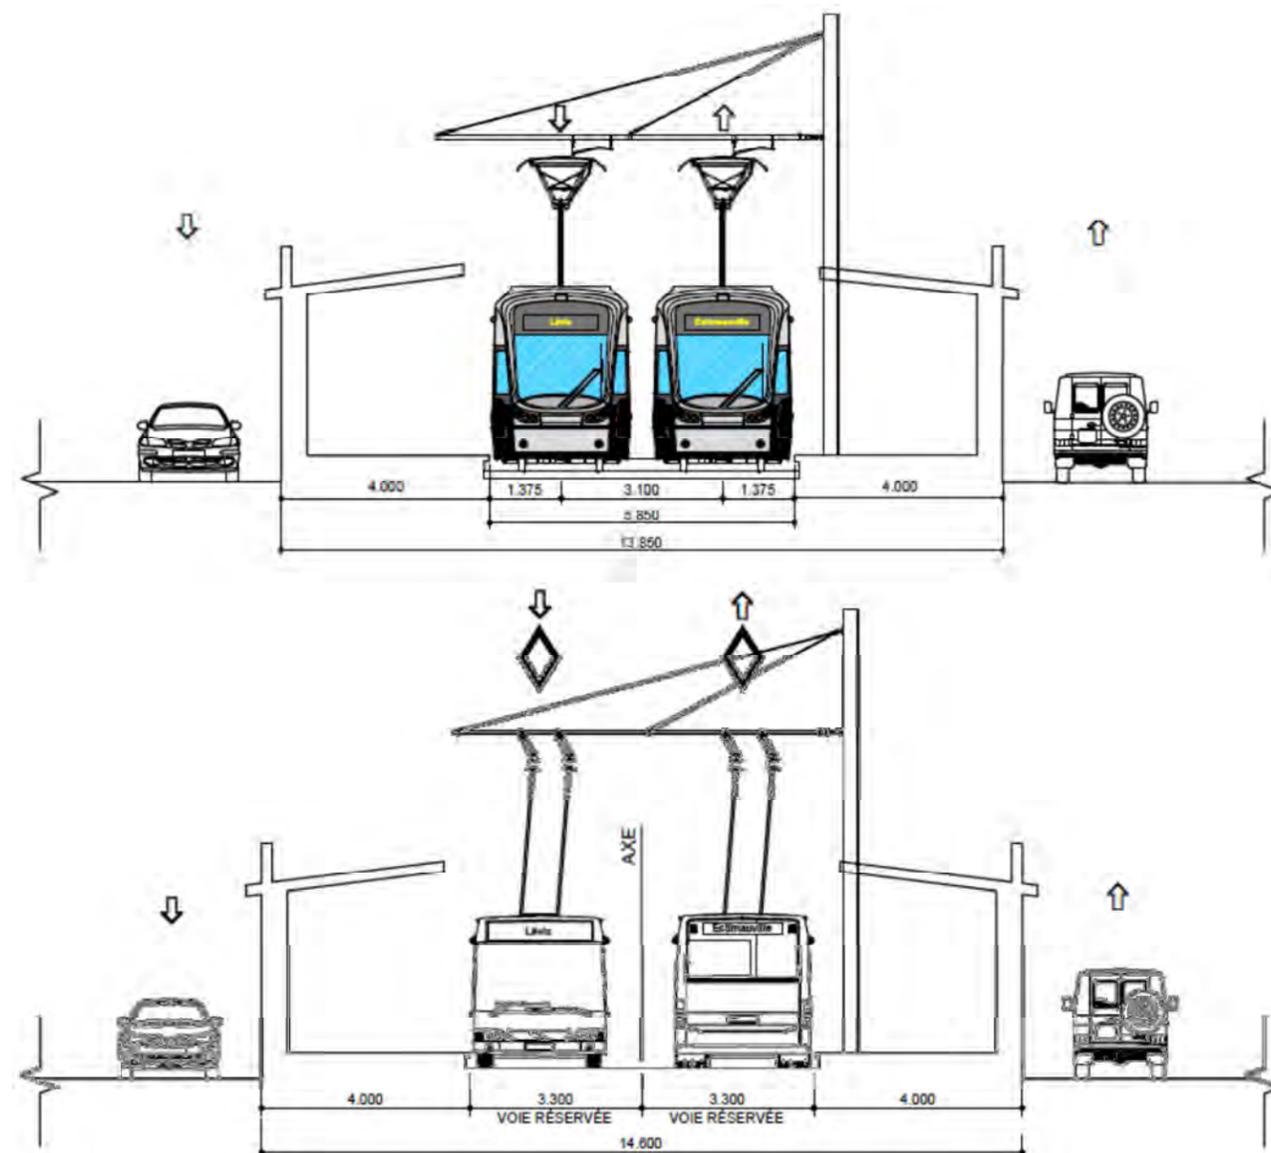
Coupe type 14 de 15 - SRB - Site propre standard en station - Quais latéraux
